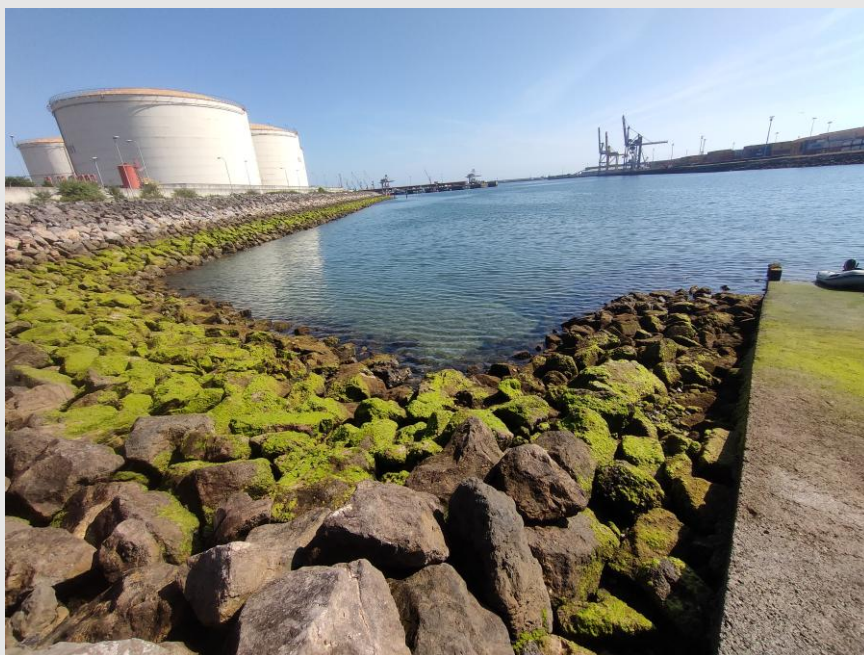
Estado actual de la zona donde se va a construir la Hatchery
